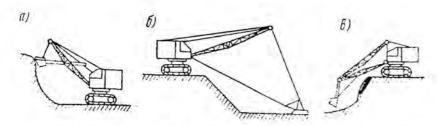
Разработка грунта. Место разработки грунта экскаватором называют забоем.
